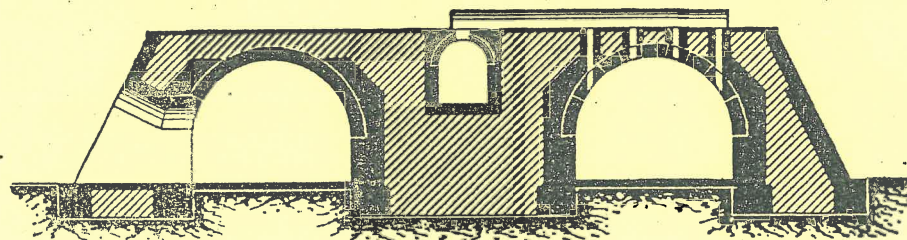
Ringofen mit oberem Rauchabzug. Querschnitt.
